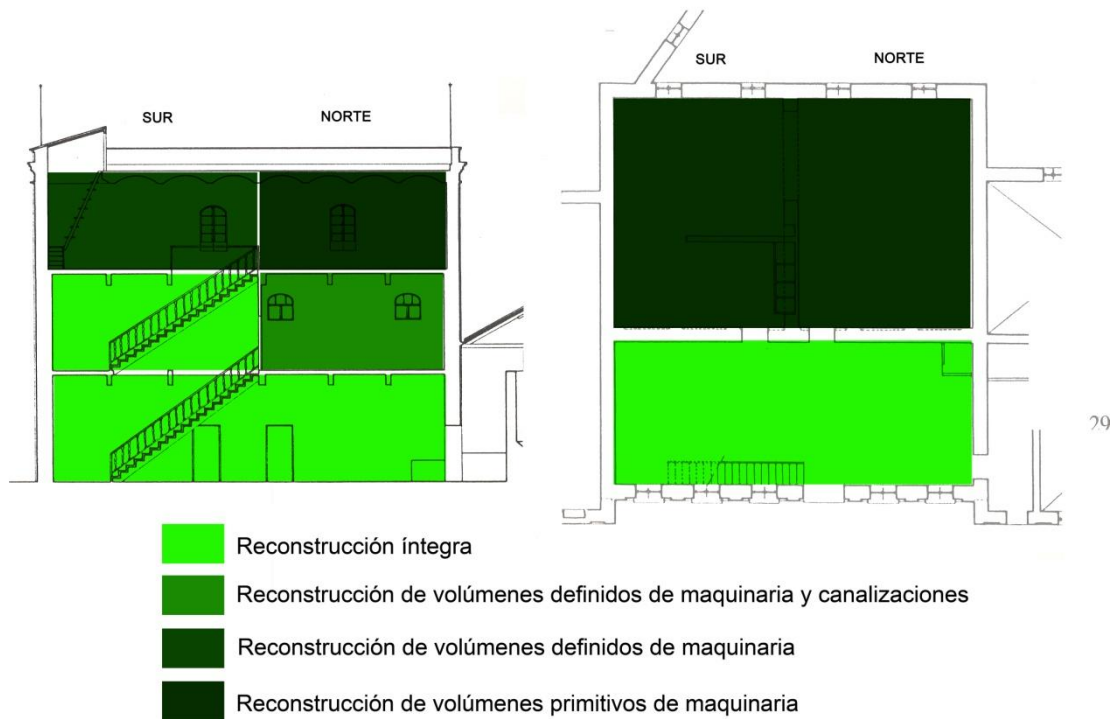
Esquema de reconstrucción de la maquinaria. Por plantas (izq.) y planta baja (dcha.).
